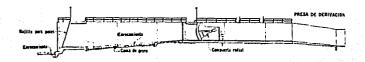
OBRA DE TOMA CON REJILLA PARA BASURAS, CANAL ABIERTO Y COMPUERTA RADIAL.
